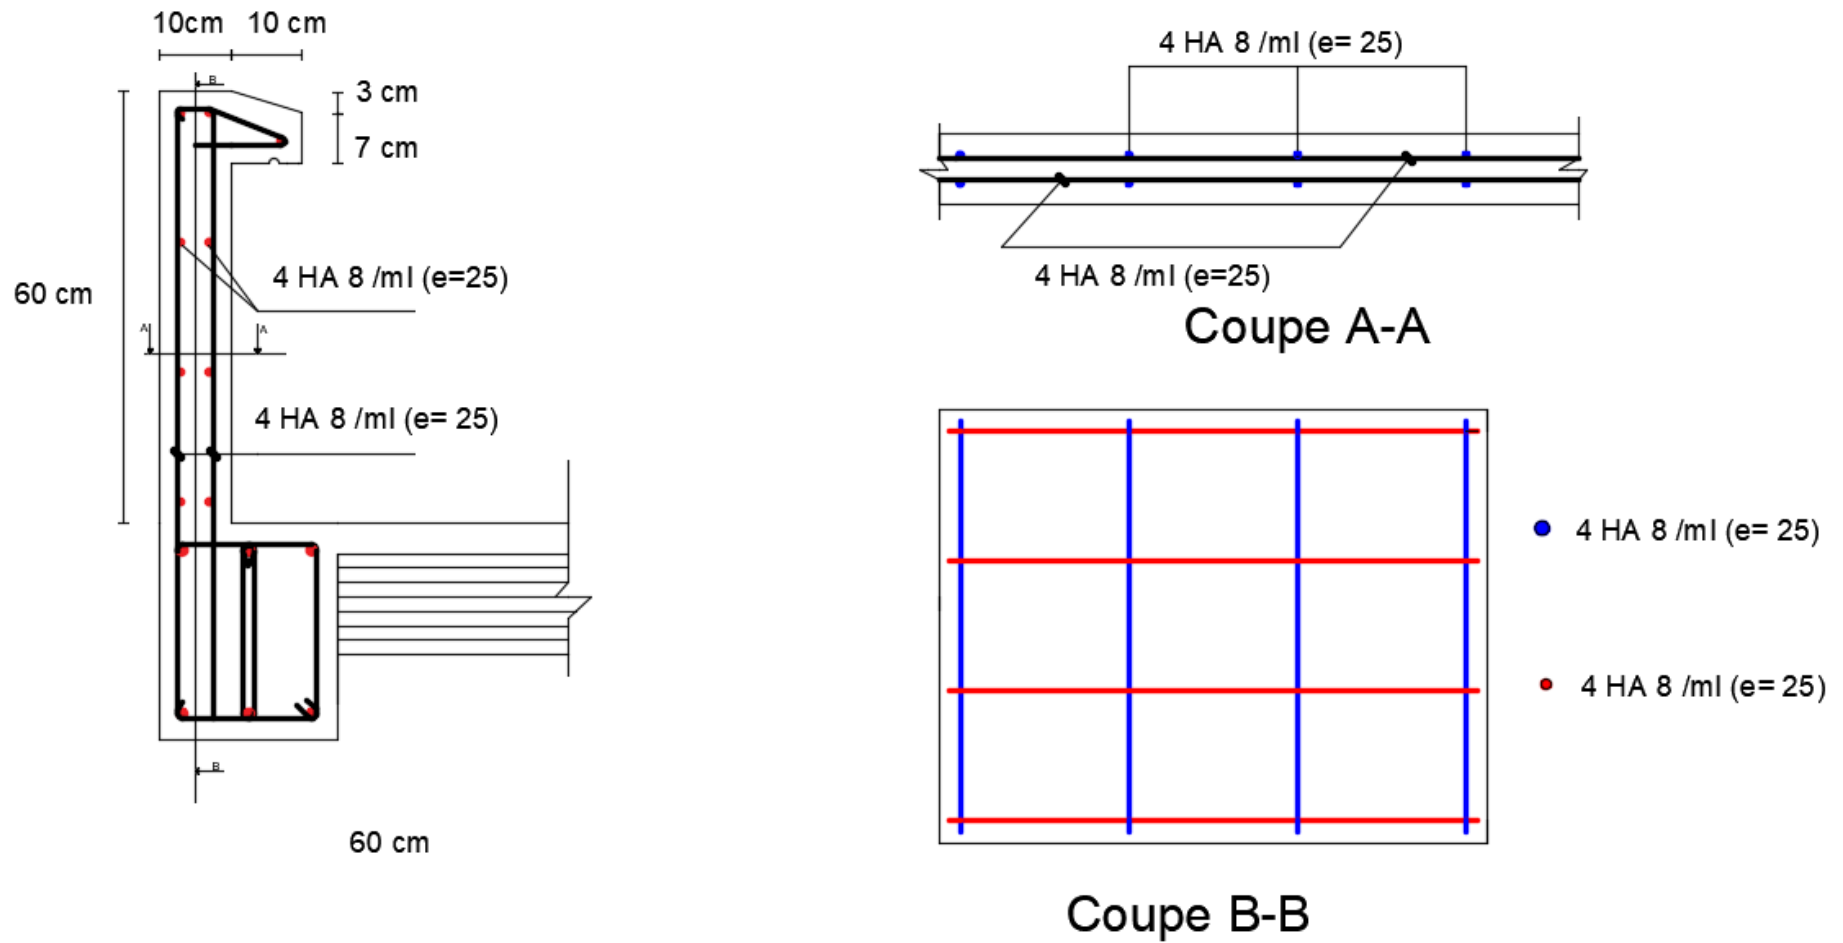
Plan de ferrailage de l'acrotère.
